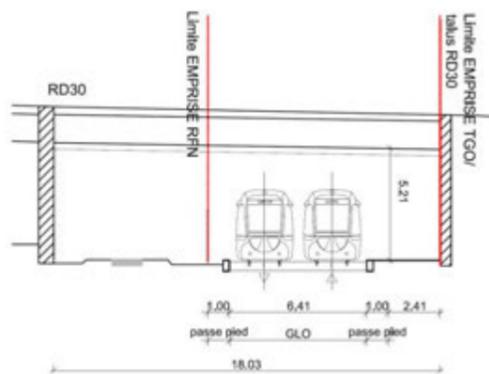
Vue en coupe (AA' sur vue en plan) de l'ouvrage sous la RD 30
